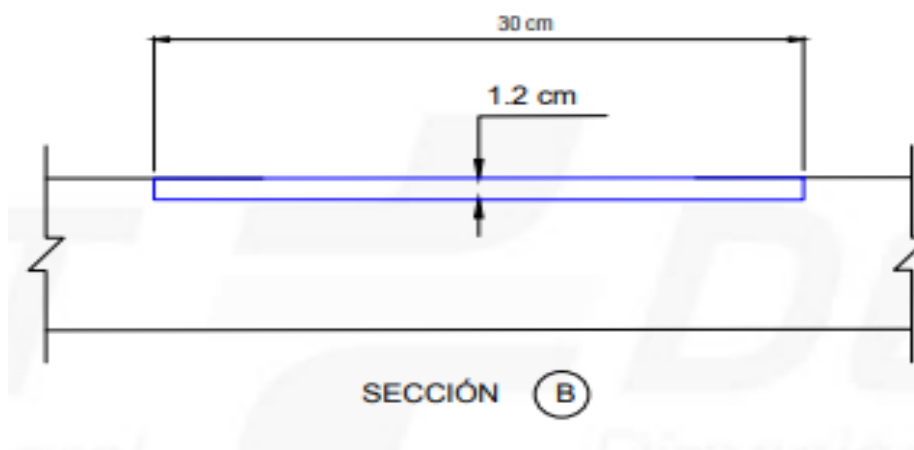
DGT (2018). Sección transversal de guía sonora longitudinal paralelogramo.
